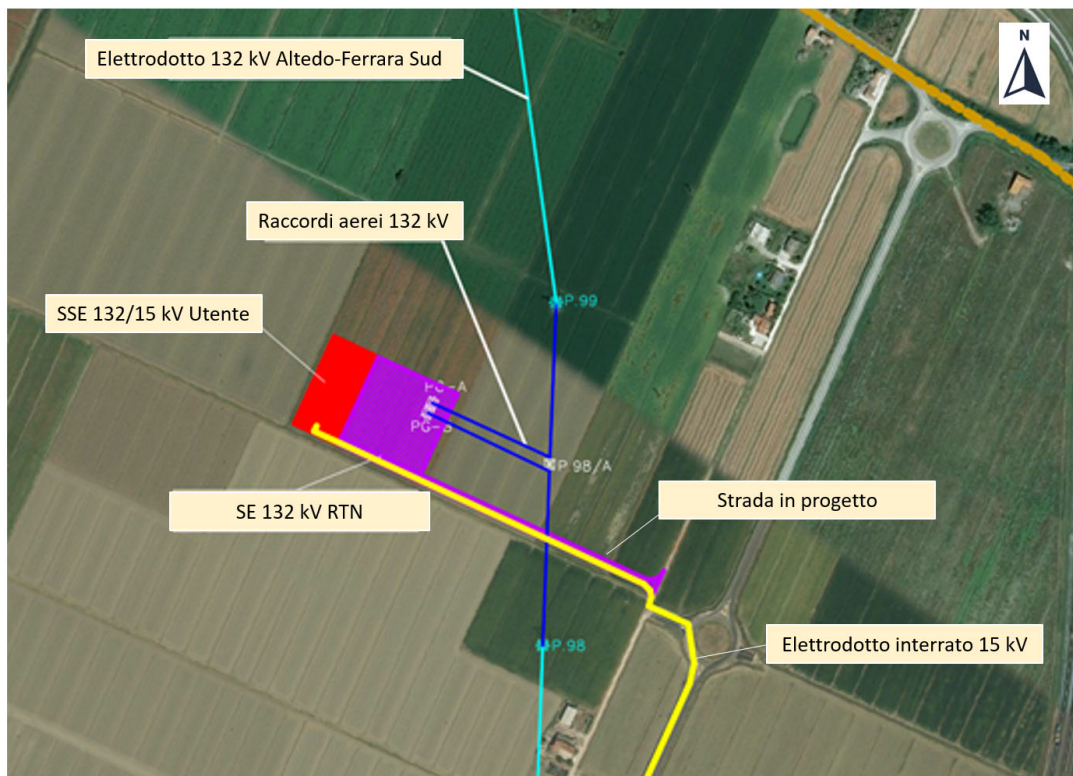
Posizionamento Stazione Elettrica RTN (in blu linea AT 132 kV a cui si collega)
